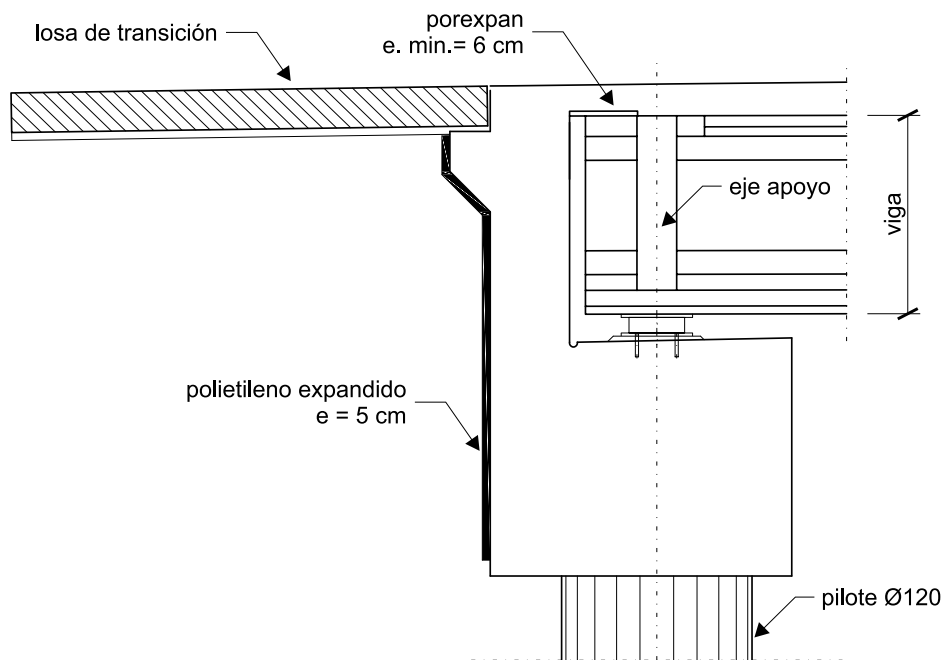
Detalle de continuidad losa superior de tablero-murete de estribo
